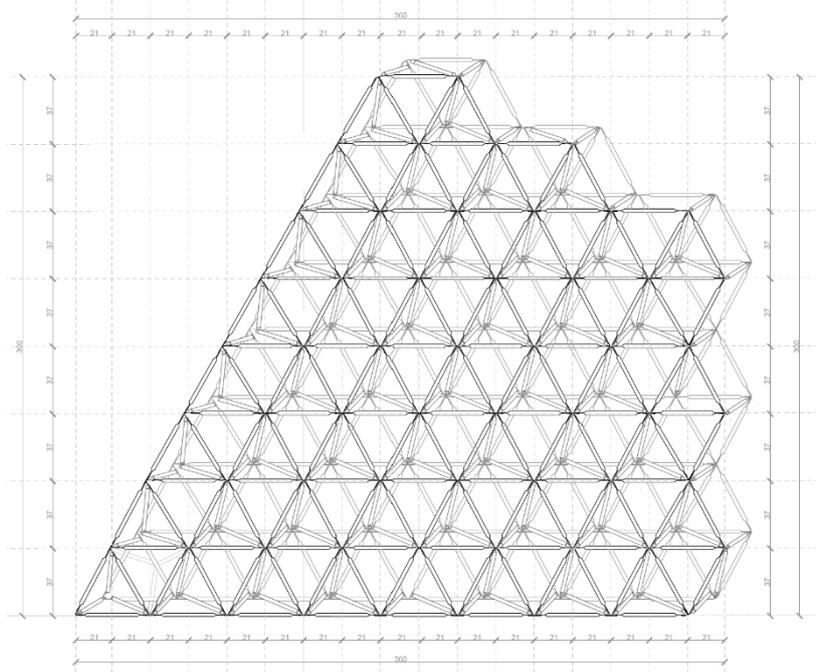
Planta cubierta reticulada. Fuente: Elaborado por estudiantes MySE II 202410
